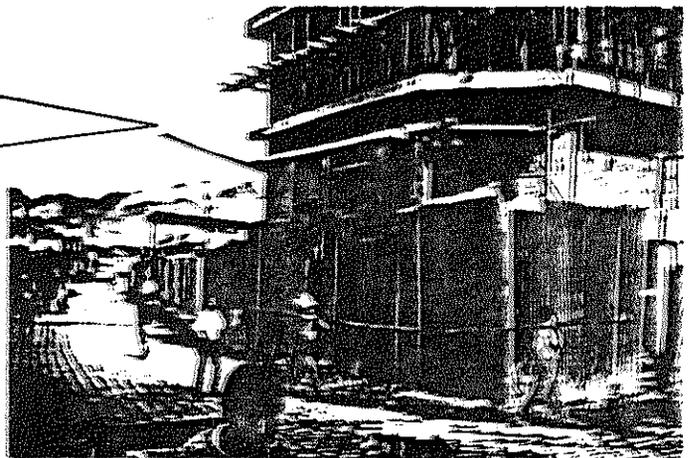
Construcción de tres plantas en proceso, donde los materiales principales son el ladrillo itz'atya, el block y concreto reforzado. Este inmueble albergará local comercial, oficinas y apartamento en la primera, segunda y tercera planta respectivamente.
